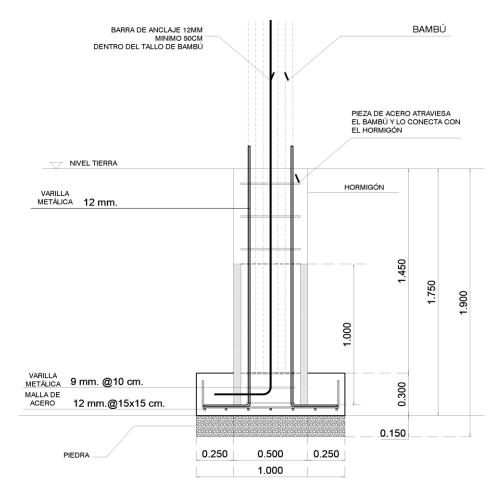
Detalle constructivo Cimentación Bamboo Sports Hall
